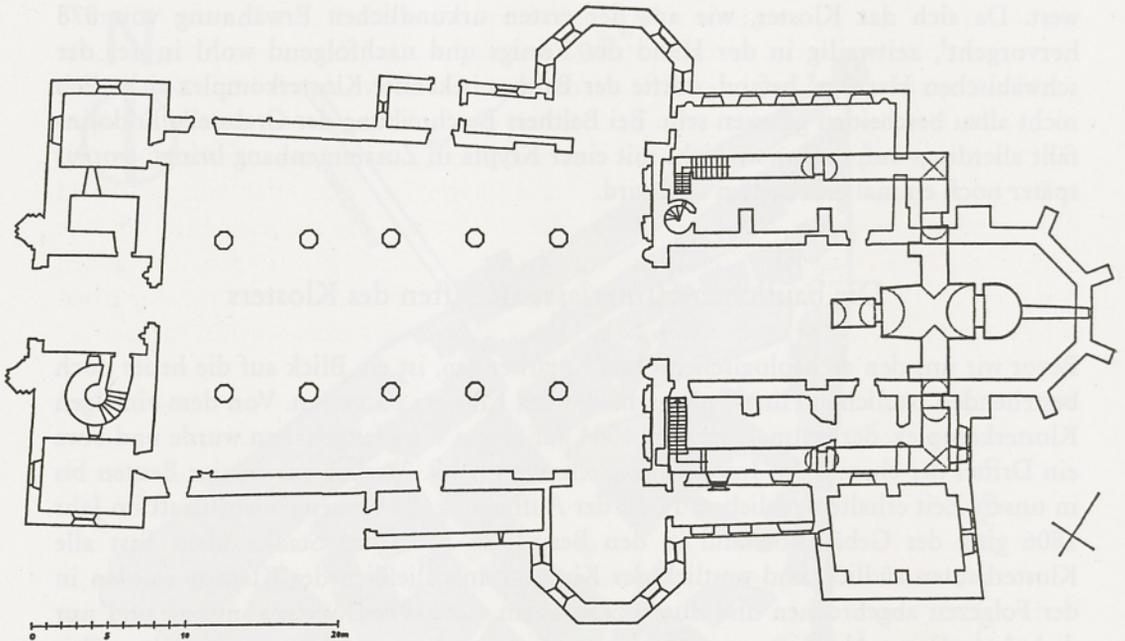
Grundriß des Säckinger Münsters mit der älteren Krypta unter dem gotischen Chor und dem älteren Westbau zwischen den barocken Seitenkapellen. Staatliches Vermögens- und Hochbauamt Konstanz, Bauleitung Waldshut.
